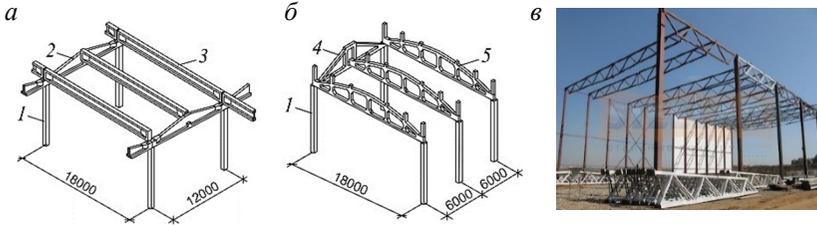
Подстропильные конструкции покрытий: *a* — железобетонные балки; *б* — железобетонные фермы; *в* — металлические фермы; 1 — колонна; 2 — подстропильная балка; 3 — стропильная балка; 4 — подстропильная ферма; 5 — стропильная ферма
